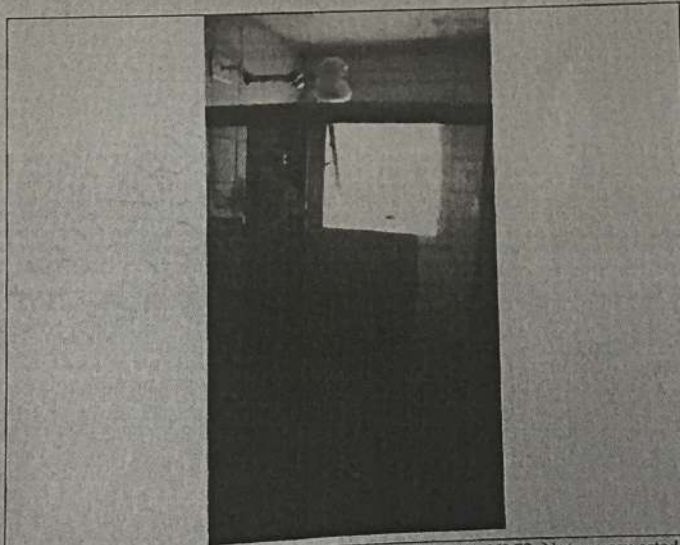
Outro detalhe do Banheiro do Apartamento Nº 72. Nota-se seu estado de conservação e os diversos materiais de acabamento e construção.
